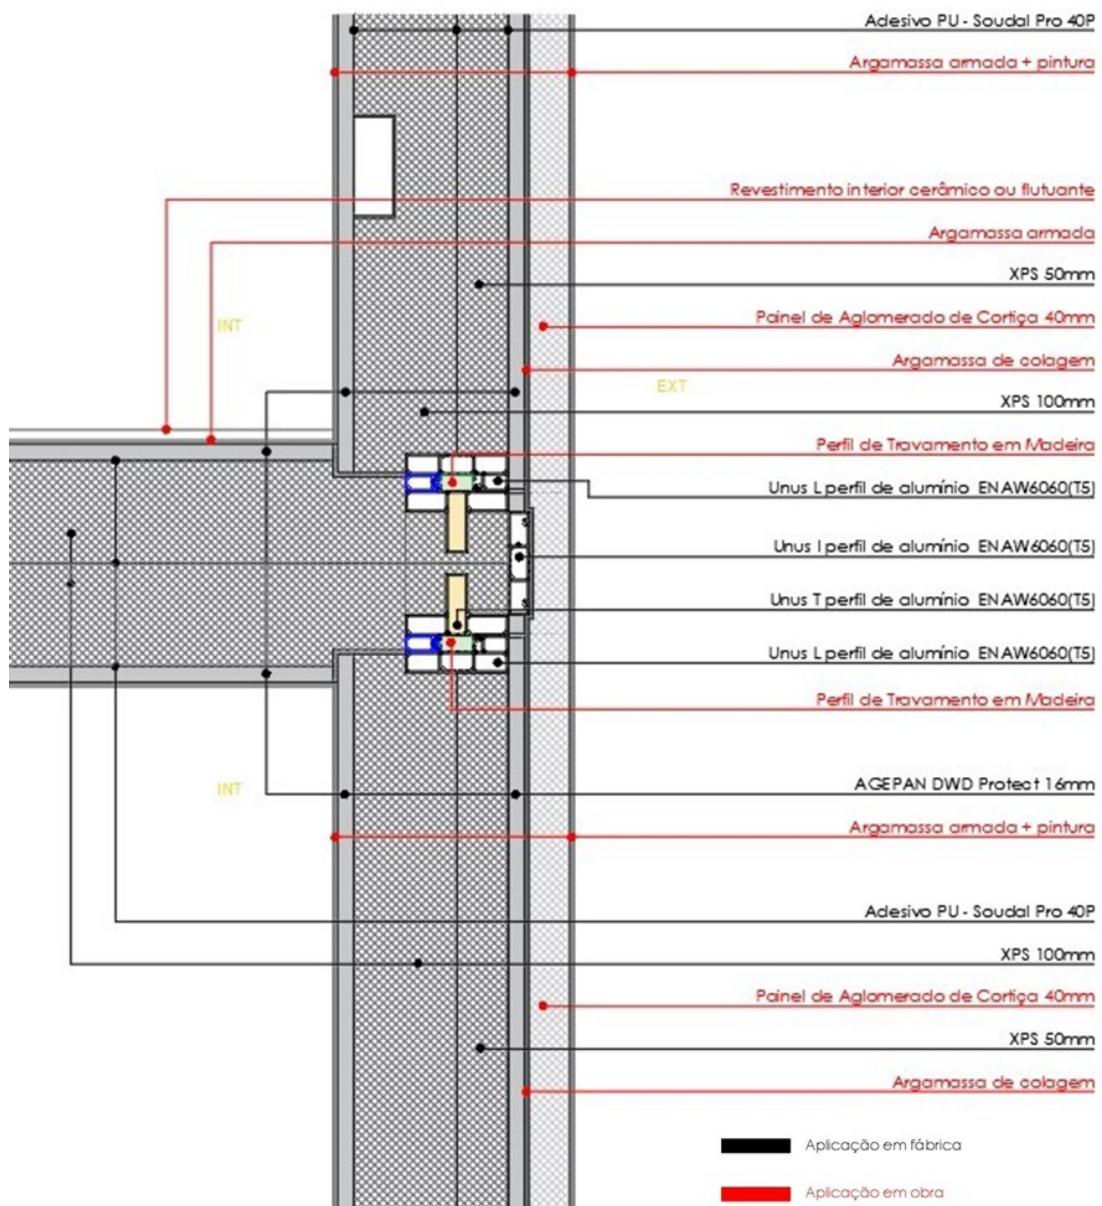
Solução Final – Pormenor construtivo de pisos intermédios/ paredes.
